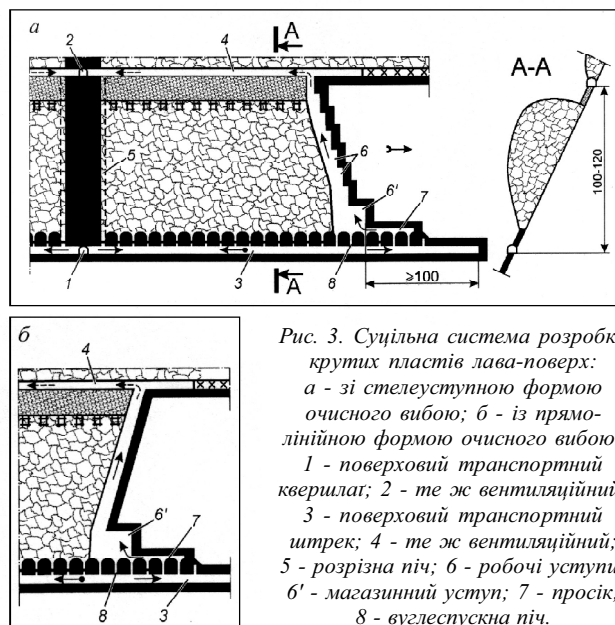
Суцільна система розробки крутих пластів лава-поверх: а - зі стелеуступною формою очисного вибою; б - із прямолінійною формою очисного вибою; 1 - поверховий транспортний квершилат; 2 - те ж вентиляційний; 3 - поверховий транспортний штрек; 4 - те ж вентиляційний; 5 - розрізна піч; 6 - робочі уступи; 6' - магазинний уступ; 7 - просік; 8 - вуглестускна піч.
